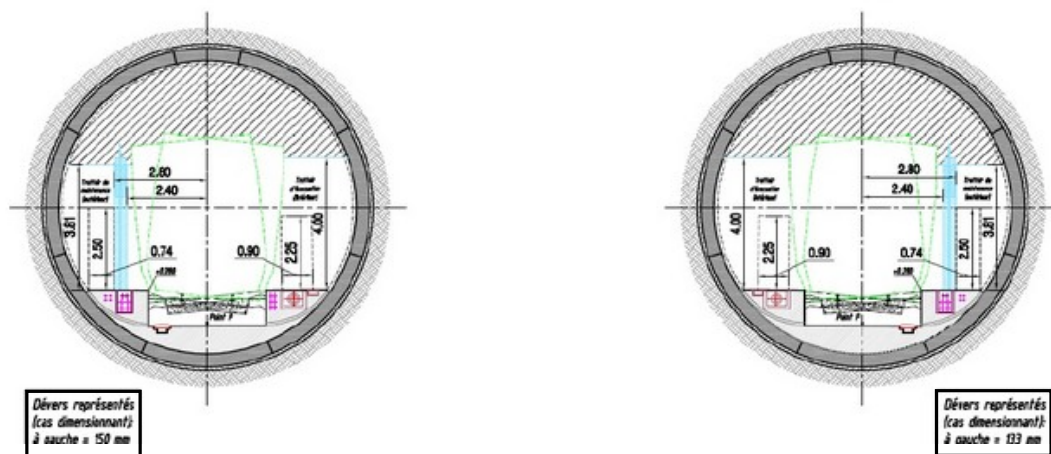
Croquis de principe des sections types de tunnel unidirectionnel (base RFF tunnel de Saverne)
